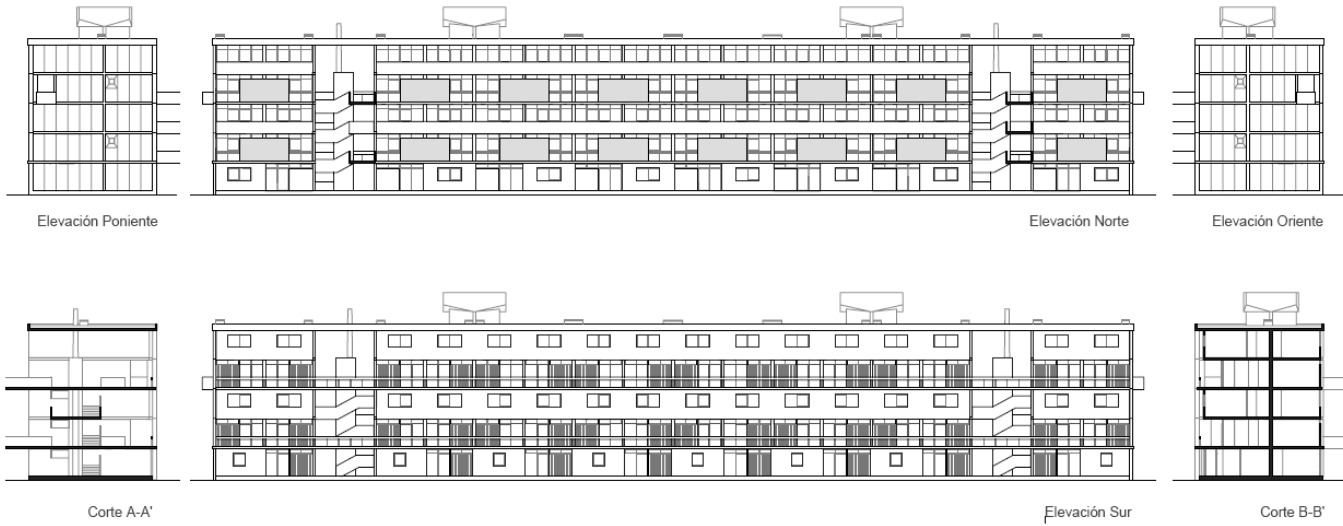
fachada longitudinal bloque dúplex interior. fuente: Becerra (2016)
